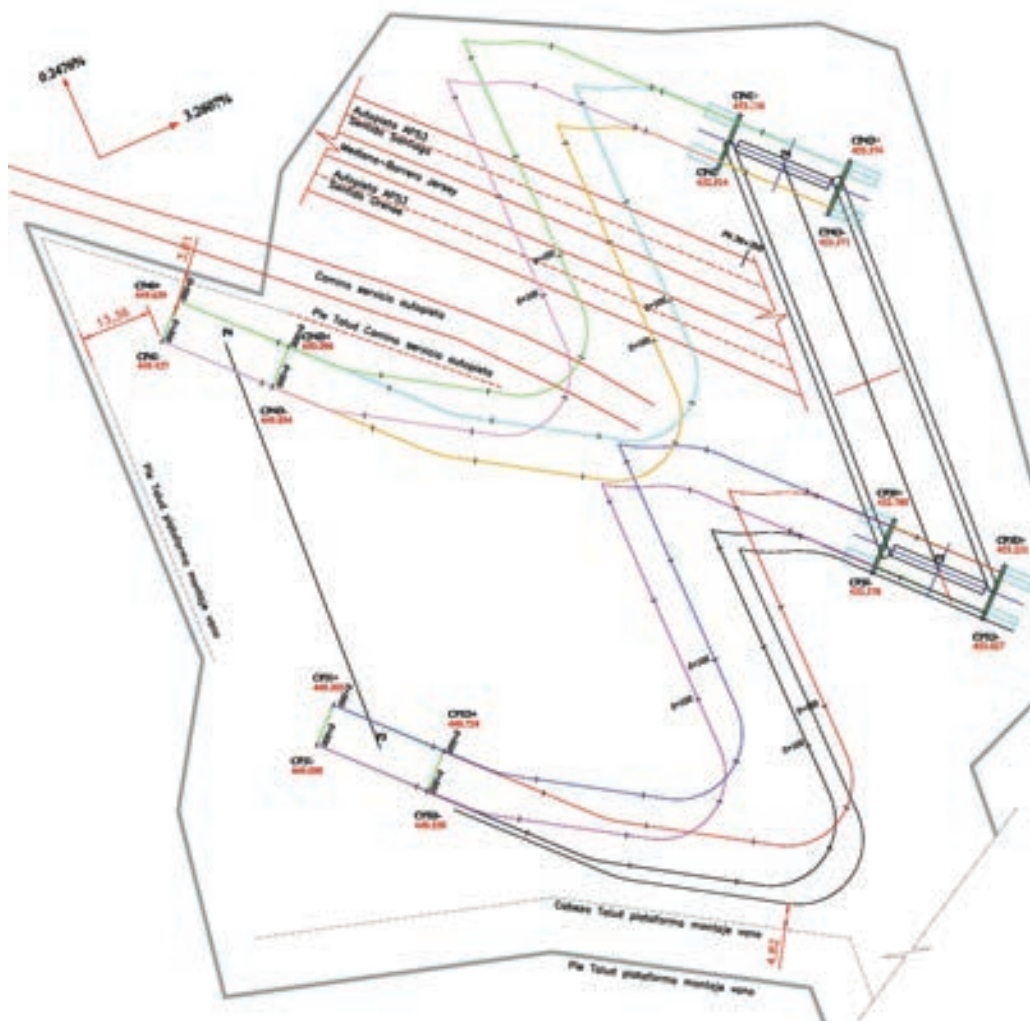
Trayectoria en planta para el traslado del vano bowstring
